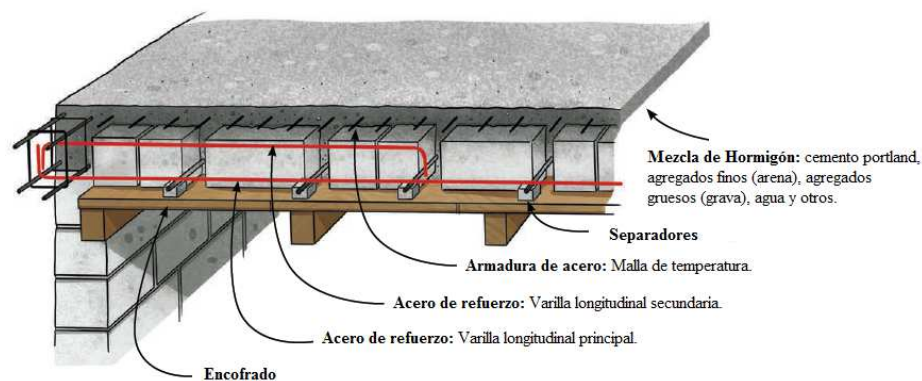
Hormigón armado empleado en la construcción de losa alivianada.
